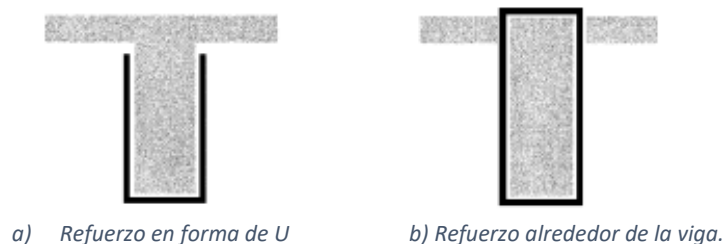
Disposición de las láminas de FRP sobre vigas de hormigón armado.
